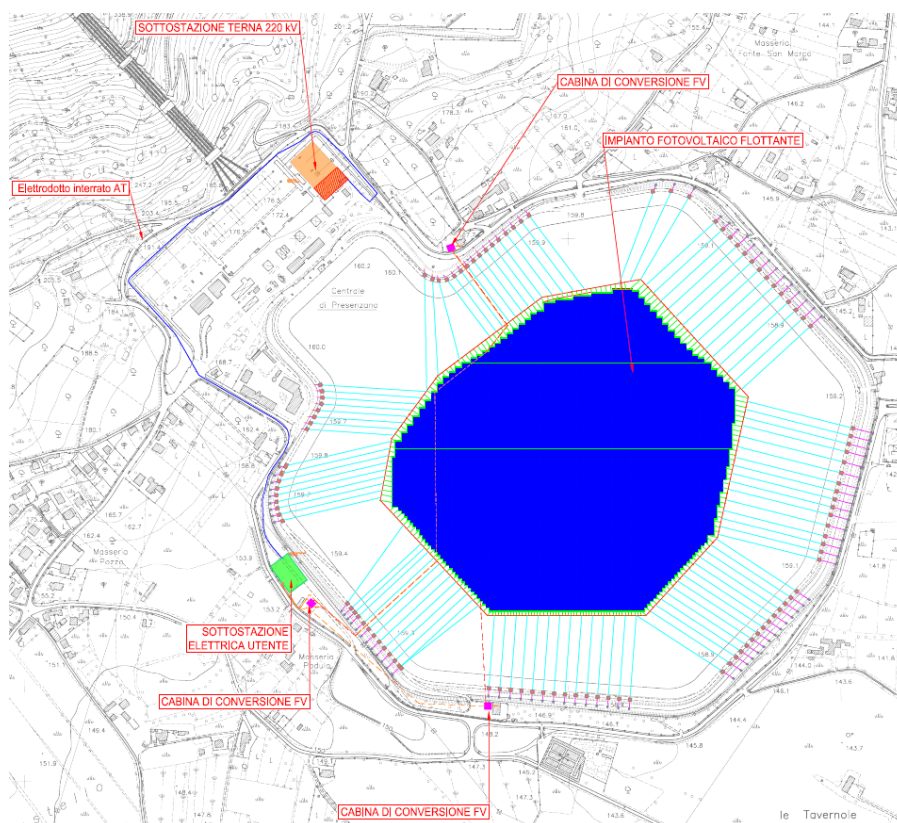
Layout su CTR per Progetto Definitivo di impianto e connessione alla RTN
